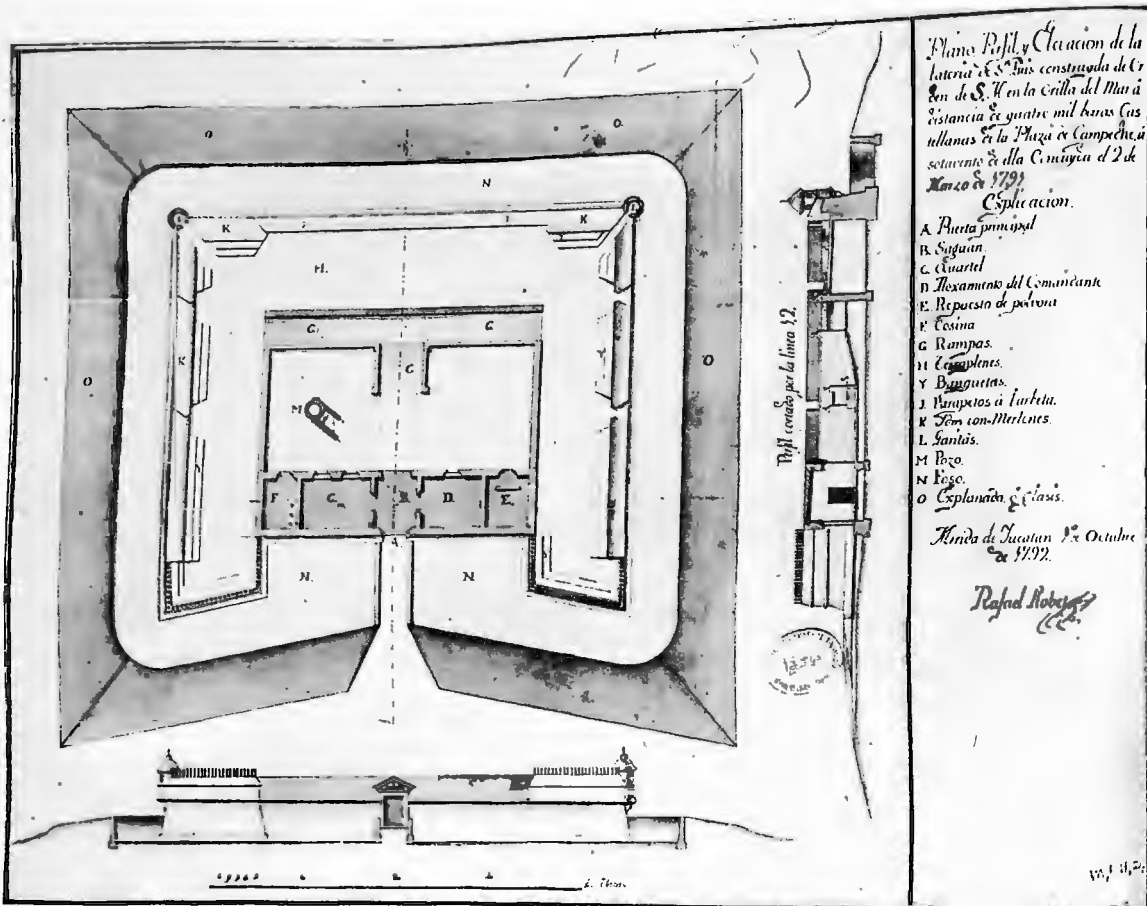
PLANO, PERFIL Y ELEVACIÓN DE LA BATERÍA DE SAN LUIS, A SOTAVENTO DE CAMPECHE, POR EL INGENIERO RAFAEL LLOBET, EN 1792
